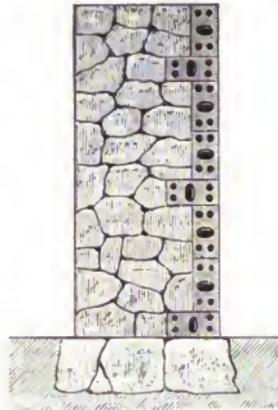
Mit Hohlziegeln bekleidete Kalkbruchsteinwand.
